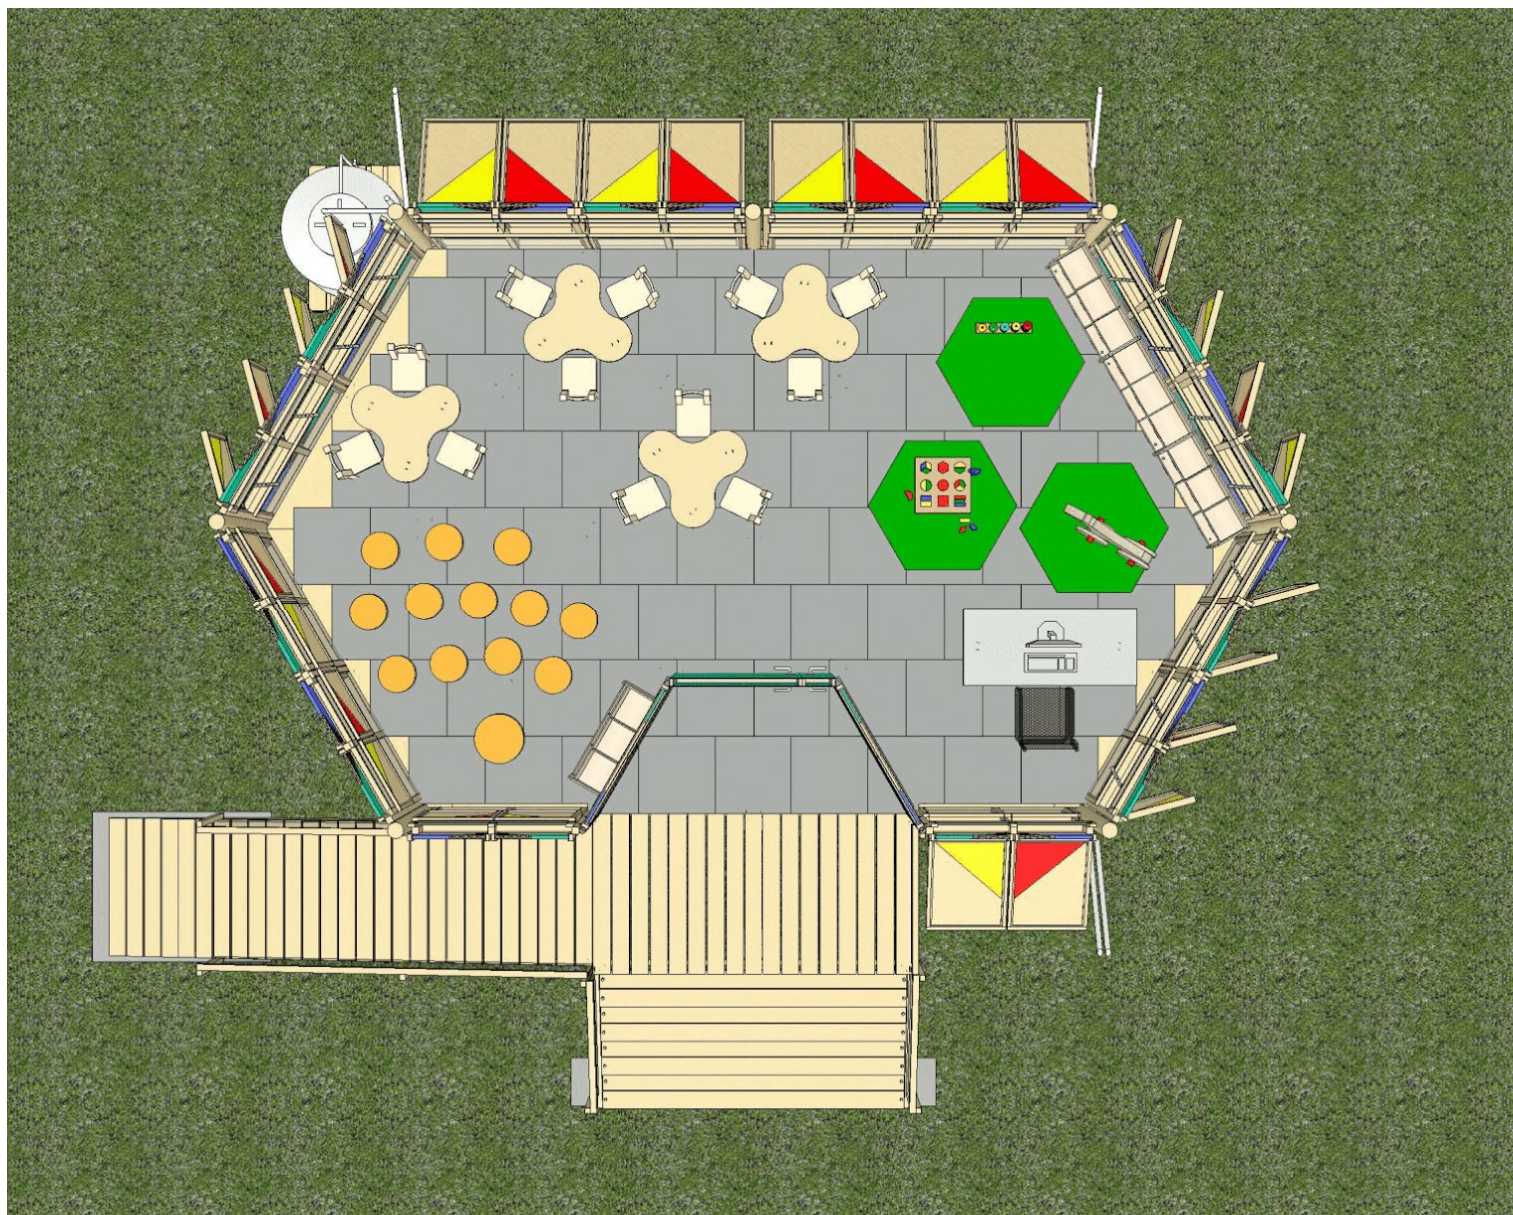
Planta de distribución arquitectónica tipología A<sup>208</sup>
